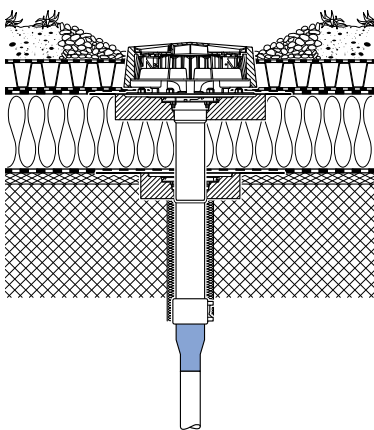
Anschluss des Geberit Pluvia Dachwassereinlaufs mit einer Reduktion
